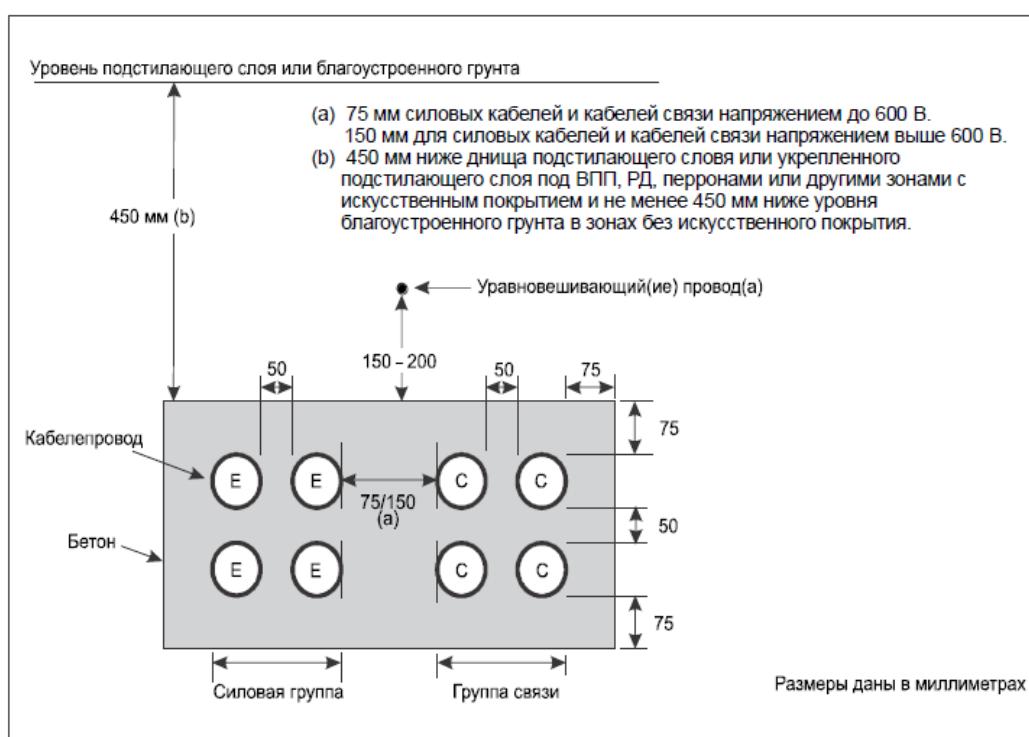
Кабельная канализация с бетонной облицовкой
